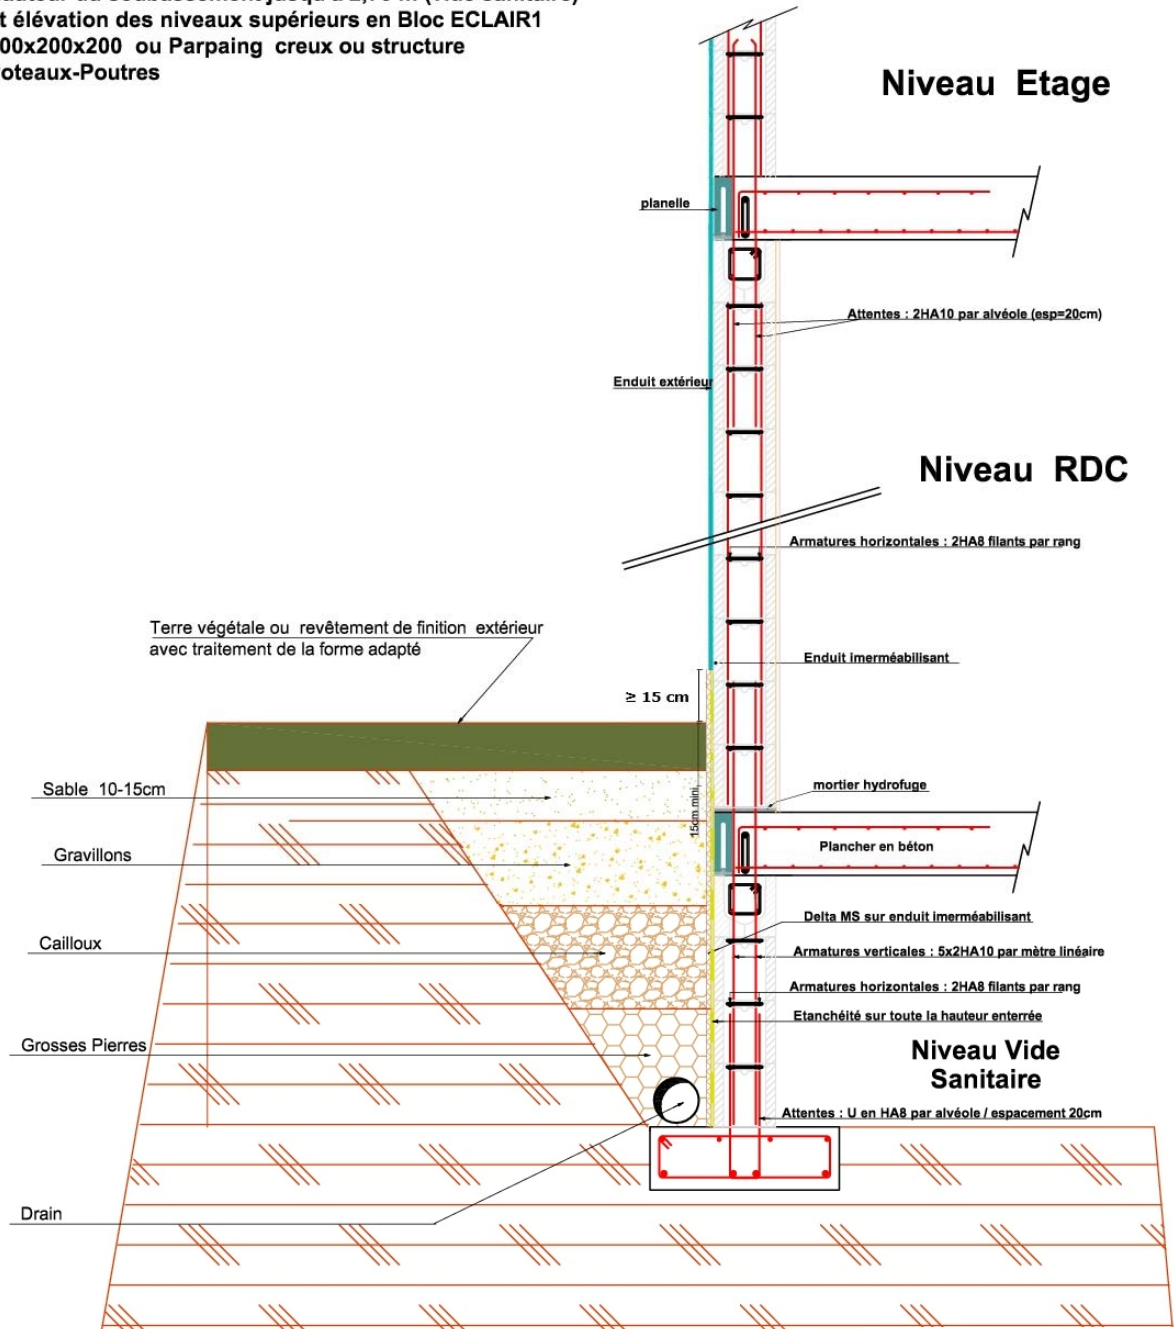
Ferrailage vertical et horizontal – soubassement (blocs 600x200x200)
